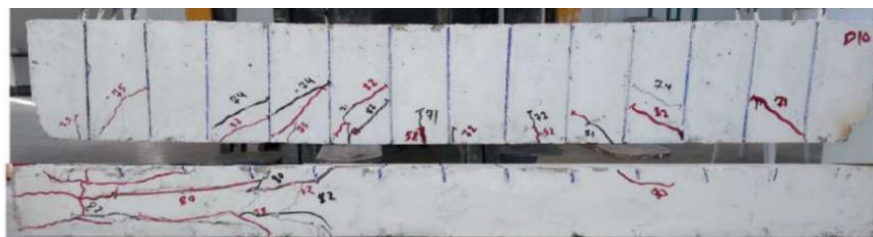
Fissuração e modo de falha para vigas danificadas a 500 e 600 °C e reparadas com laminados de CFRP
